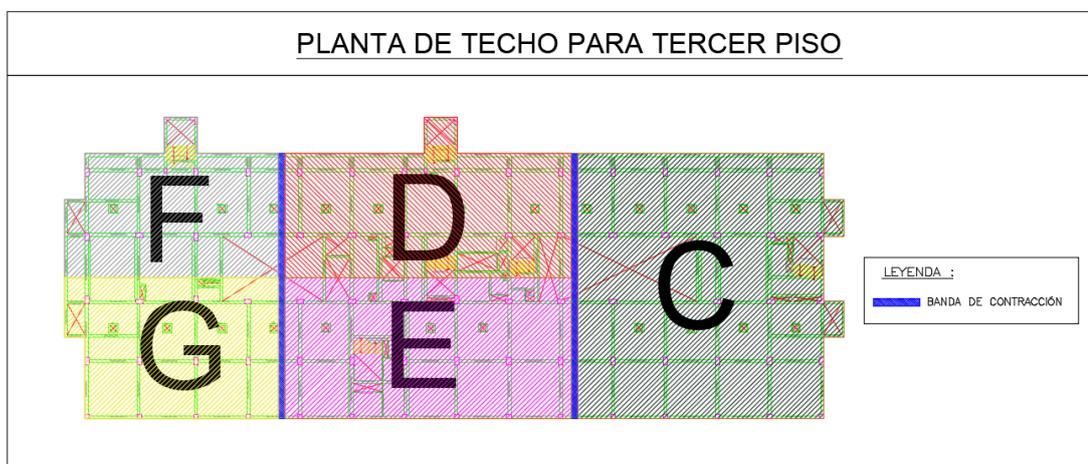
Sectorización para la Planta de Techo para Tercer Piso (Fuente: Consorcio Salud Tacna)
